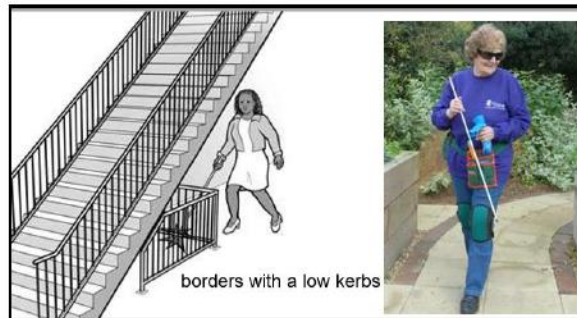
Contoh Penerapan *Handrails* Sebagai Pembatas Jalan
